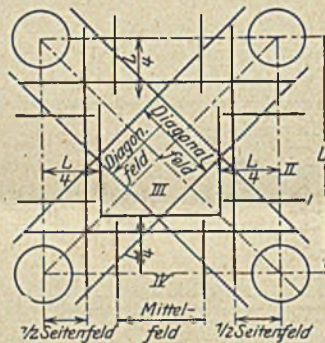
Bewehrungsschema der 4wegigen Pilzdecke.
